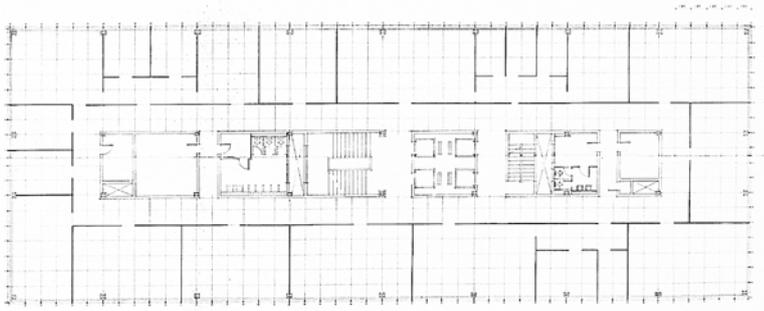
José Ferragut Pou. Planta tipo de las oficinas del Edificio GESA, Palma, 1963-1975. Archivo José Ferragut Pou
